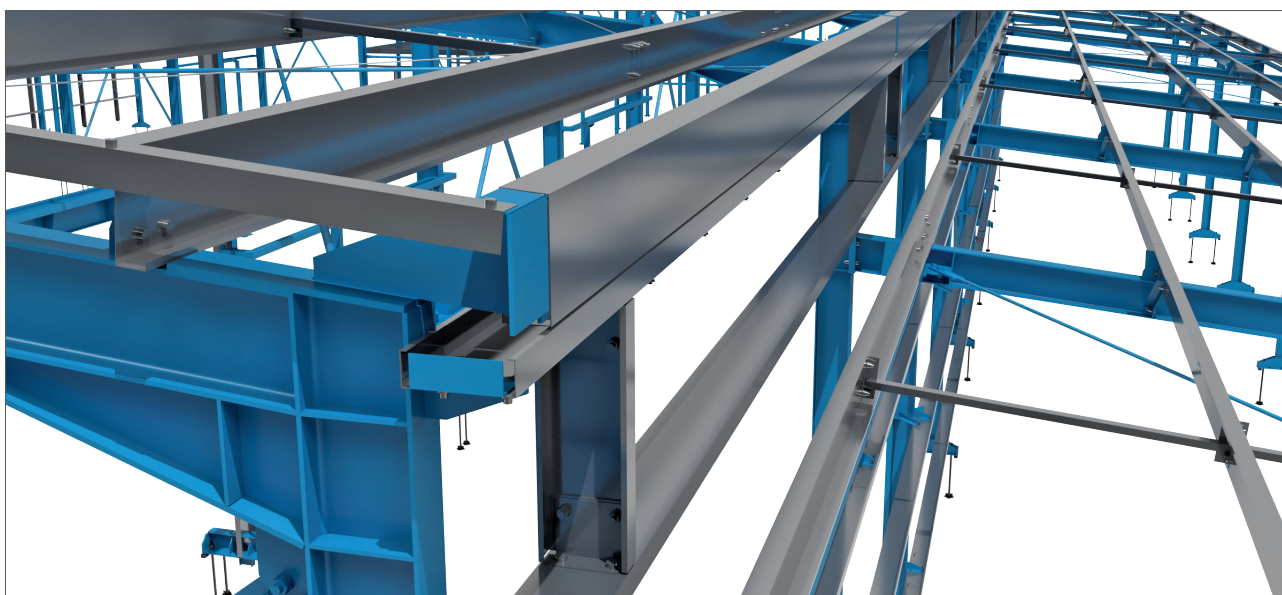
Szczegóły belki okapowej na złączu z tężnikiem okapowym
